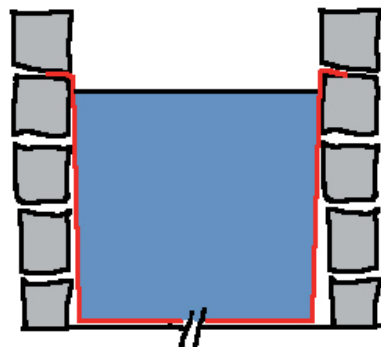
g.4 : coupe de principe de la pose d'une géomembrane
